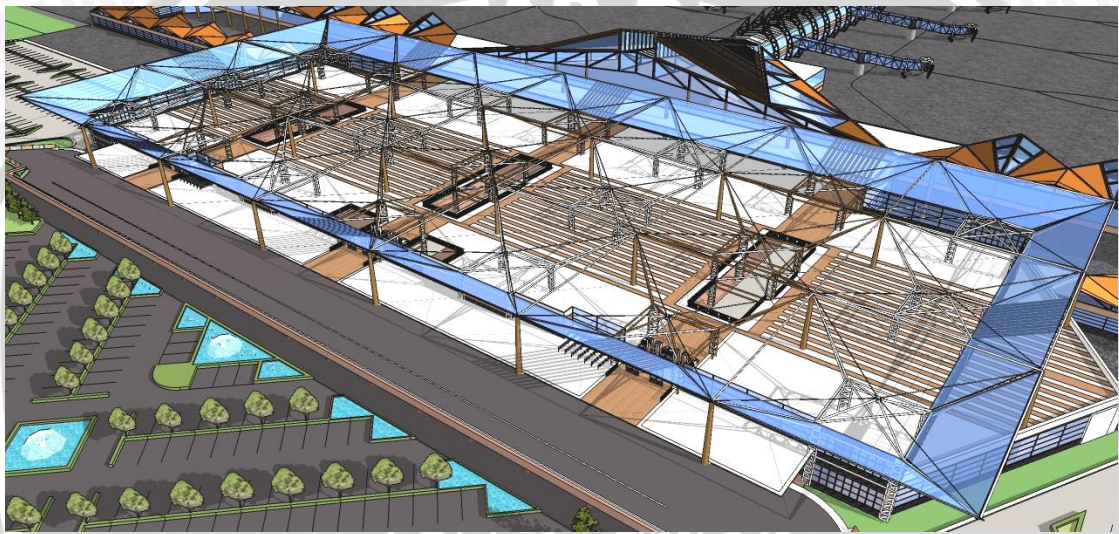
Bentuk denah terminal area kedatangan zona darat
